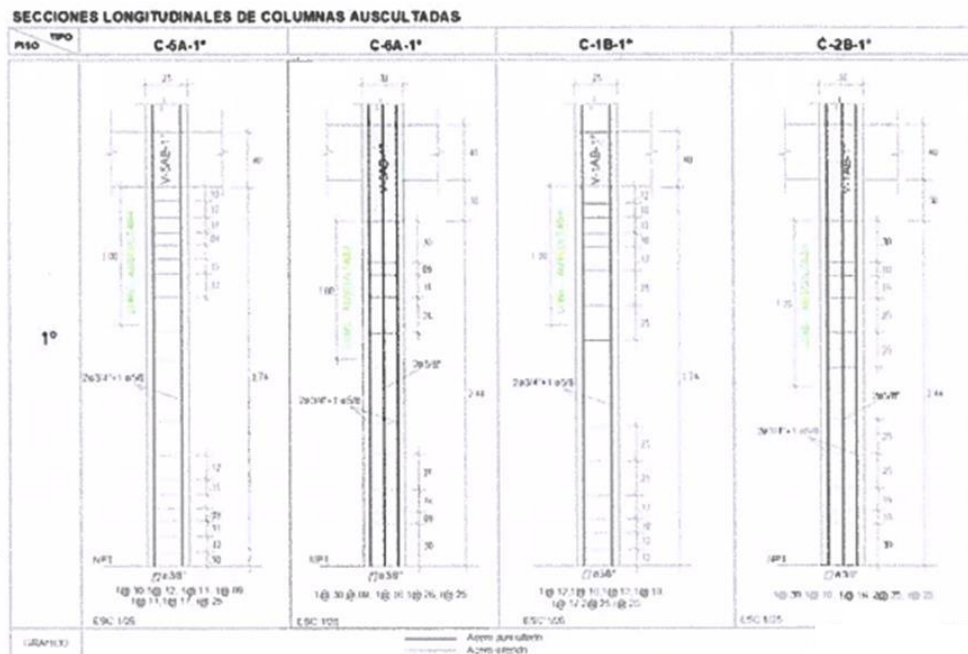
Secciones transversales de columnas auscultadas – bloque 1, piso 1°.
